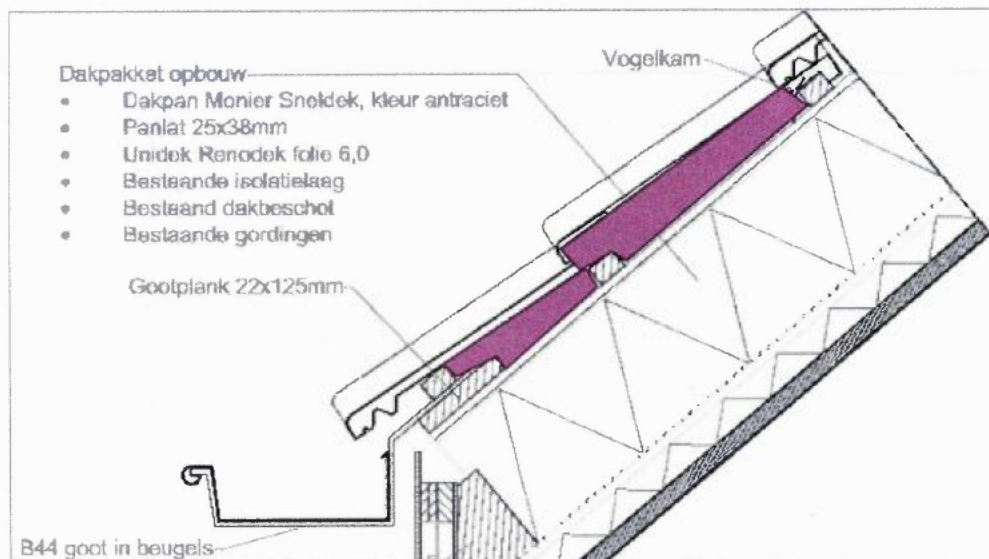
Inbouwvoorzieningen voor de vleermuisdoorsnede
